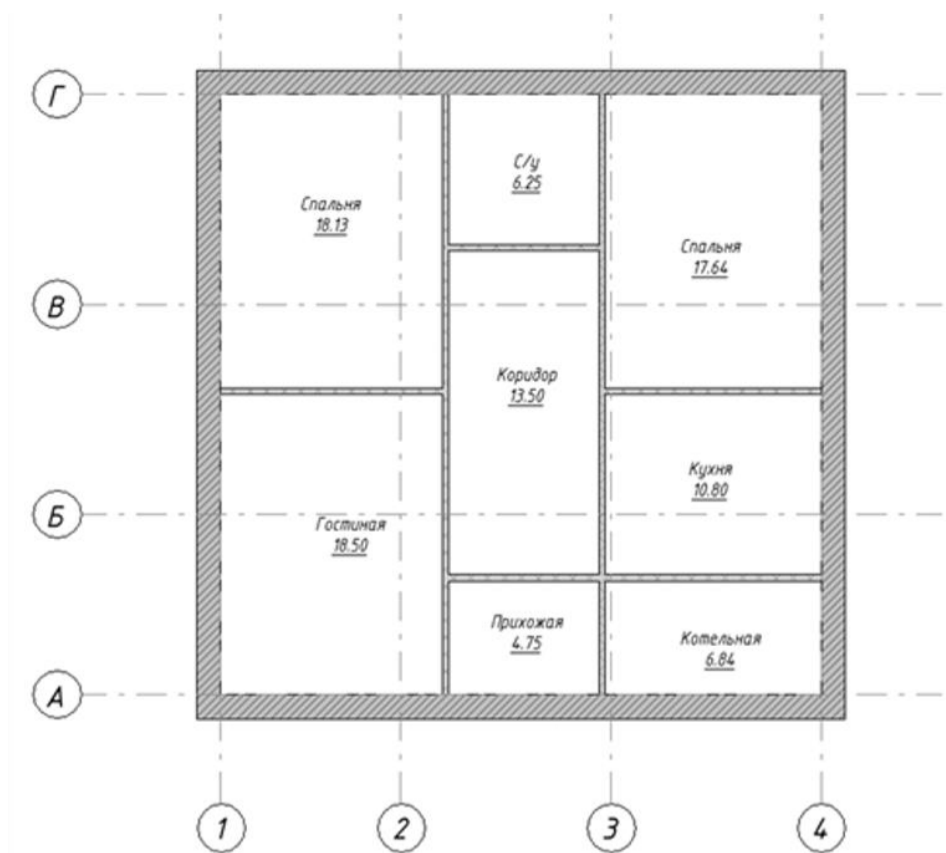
План 1-го этажа малоэтажного жилого здания
